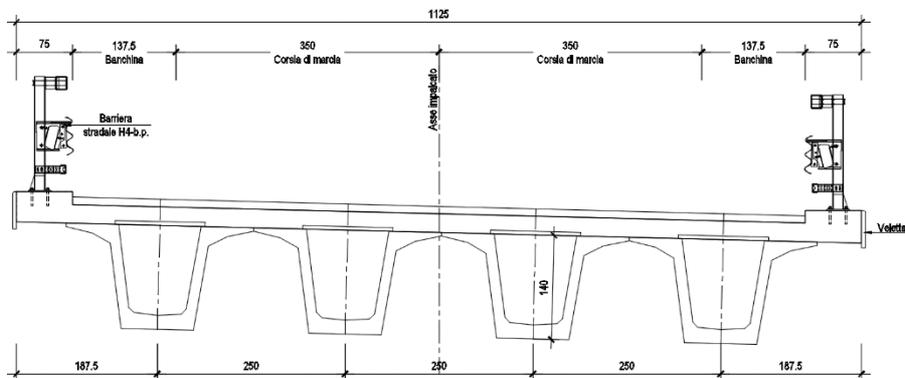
Ponte inizio lotto (pk 0+064.56) – Sezione impalcato
